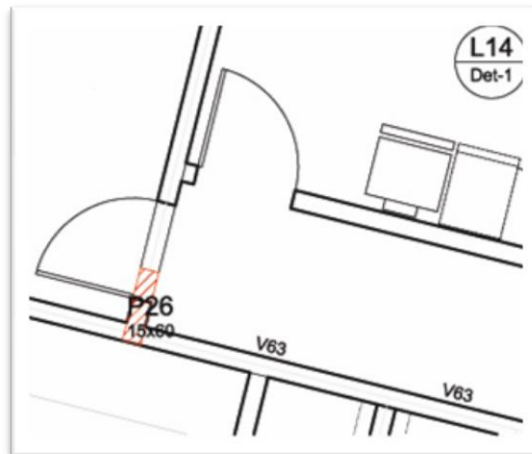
Planta baixa intersecção pilar com esquadria.
